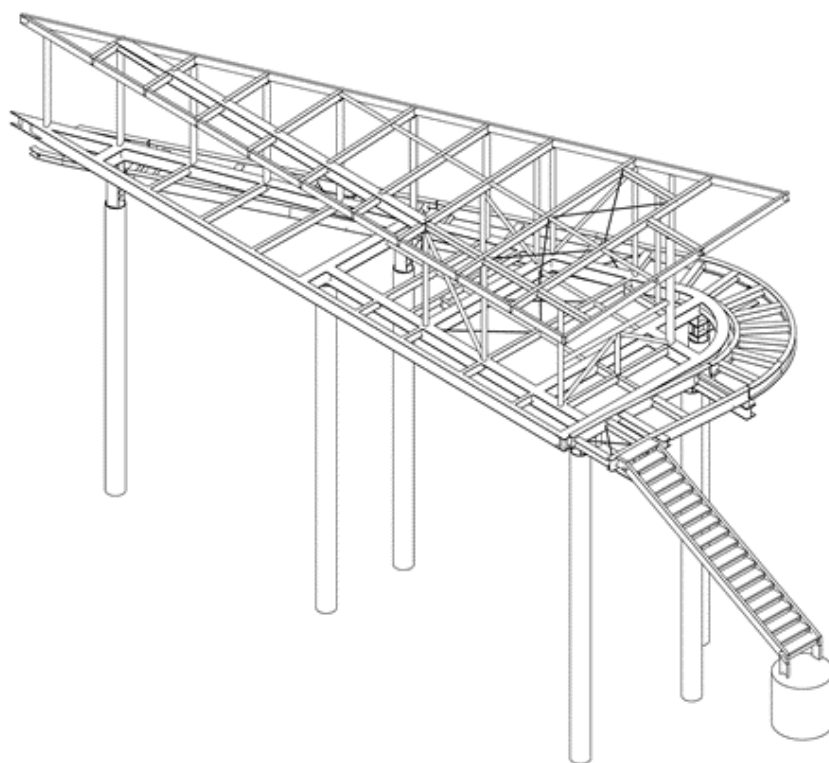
Stahlkonstruktion DLRG-Station mit Wetterschutz, Rampe und Treppe zum Strand
